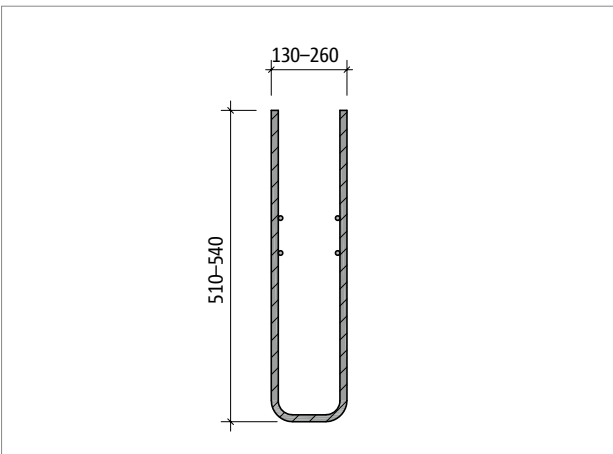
Schöck Sconnex® Typ W Part TB: Zulagebewehrung 3  $\varnothing$  12/65 mm; Bügel als Spaltzugbewehrung
